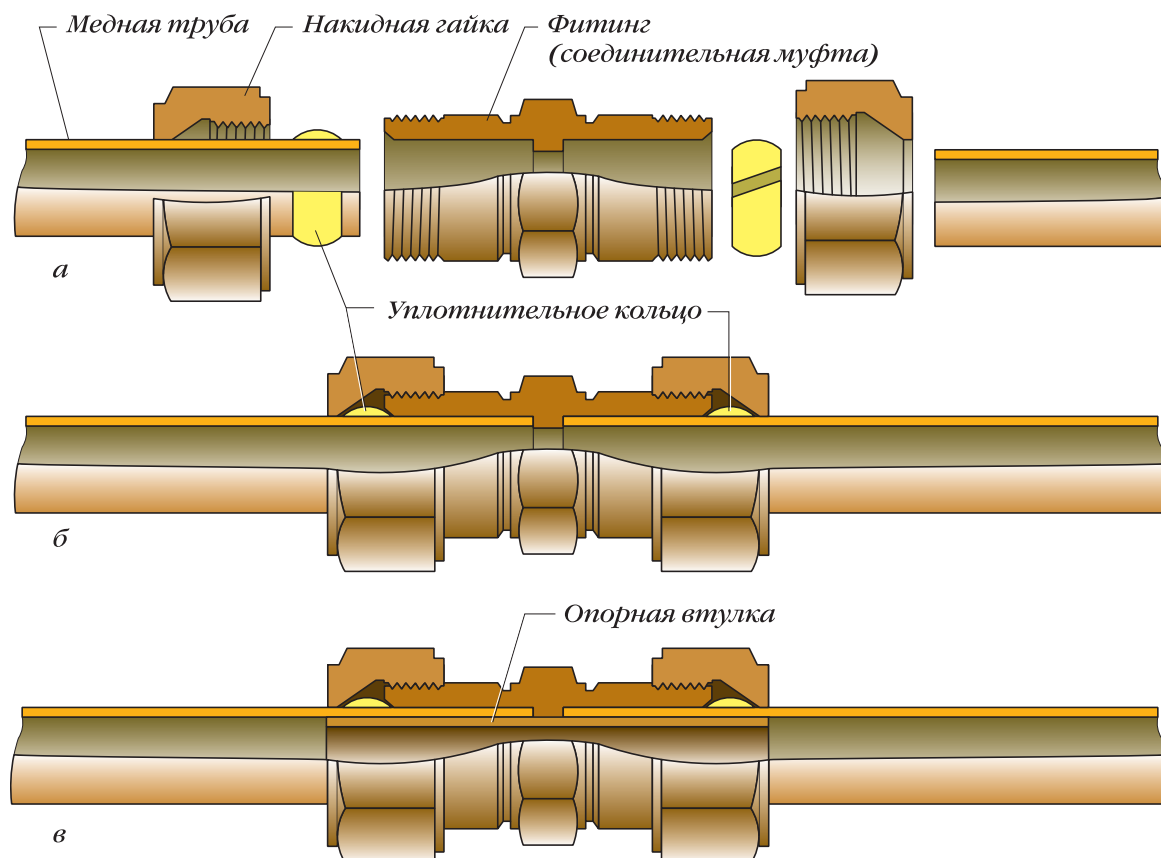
Соединение медных труб компрессионными фитингами первого типа: а — схема соединения; б — соединение твердых труб; в — соединение полутвердых и мягких труб
